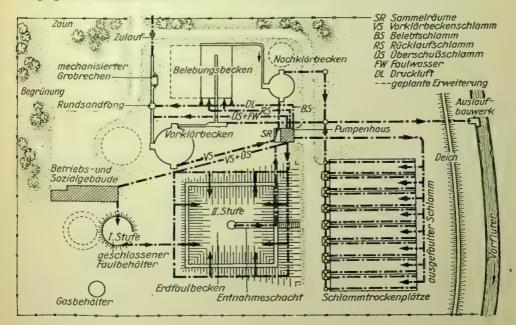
Lageplan einer Kläranlage mit Belebungsanlage und zweistufiger Faulung
